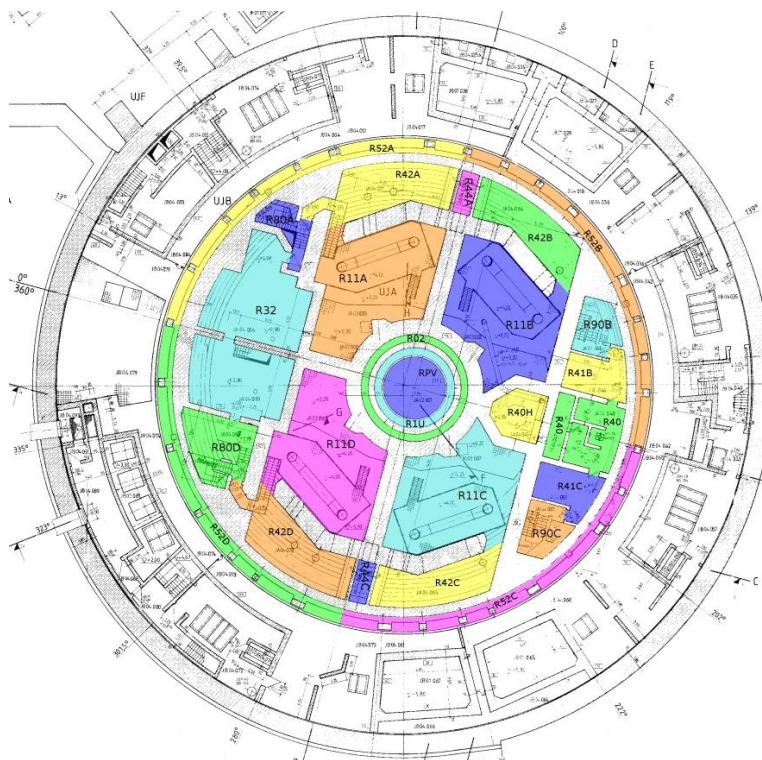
Schnitt durch den SHB bei +6,0 m (Höhenkote: 5,3 m)
